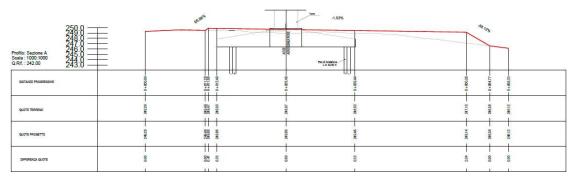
Sezione longitudinale della piazzola di montaggio T8 in rapporto al plinto di fondazione
